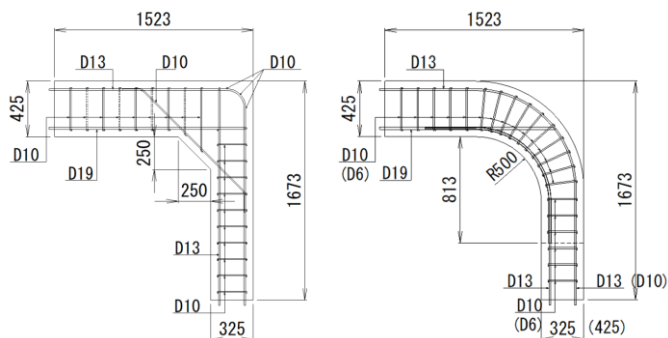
試験体配筋図 (左 : R-1, 右 : A-1 (A-2/A-3))
